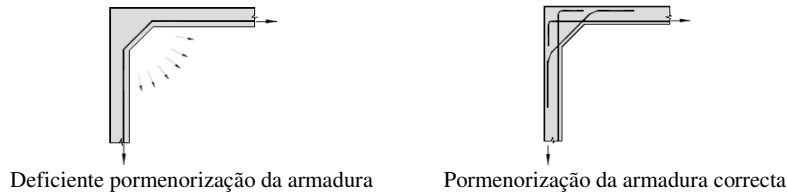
Exemplos de deficiente pormenorização de armaduras
